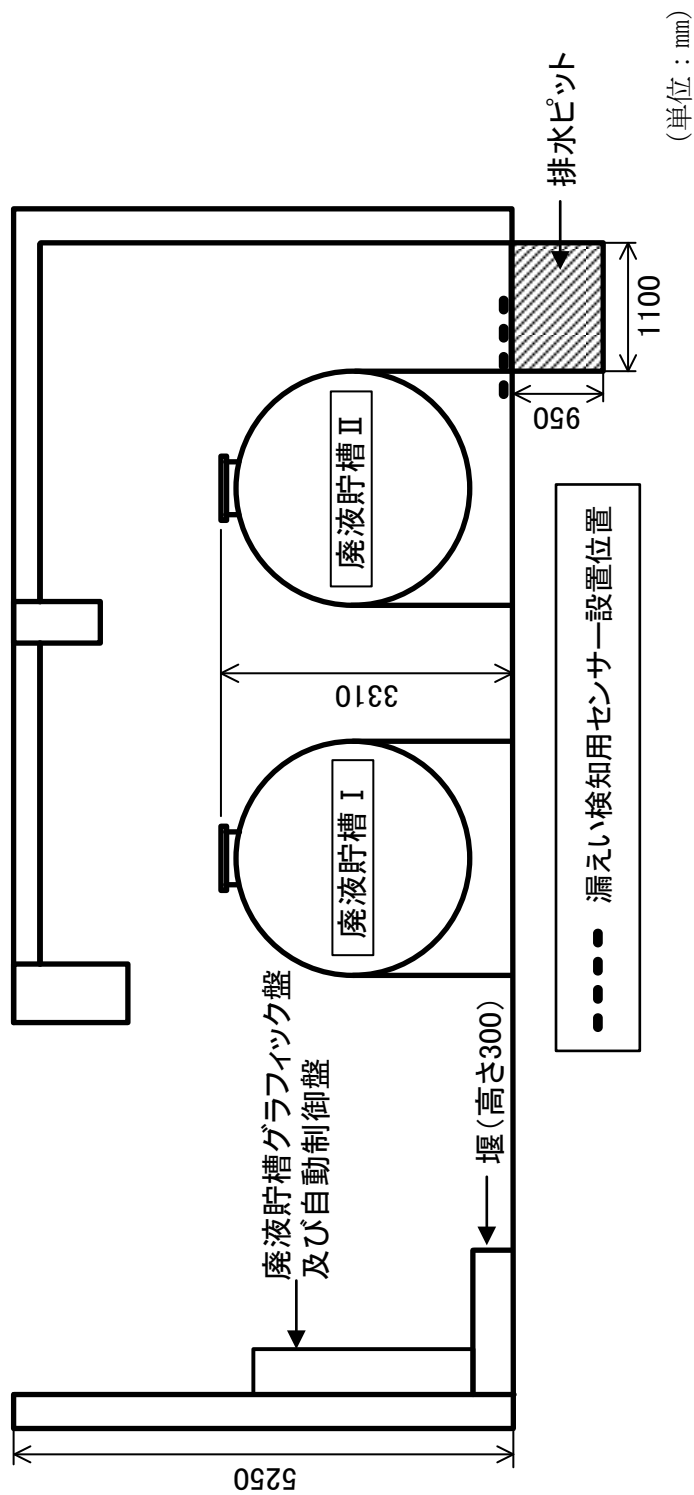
廃液貯槽の漏えい検知器の配置図 (その 3)
